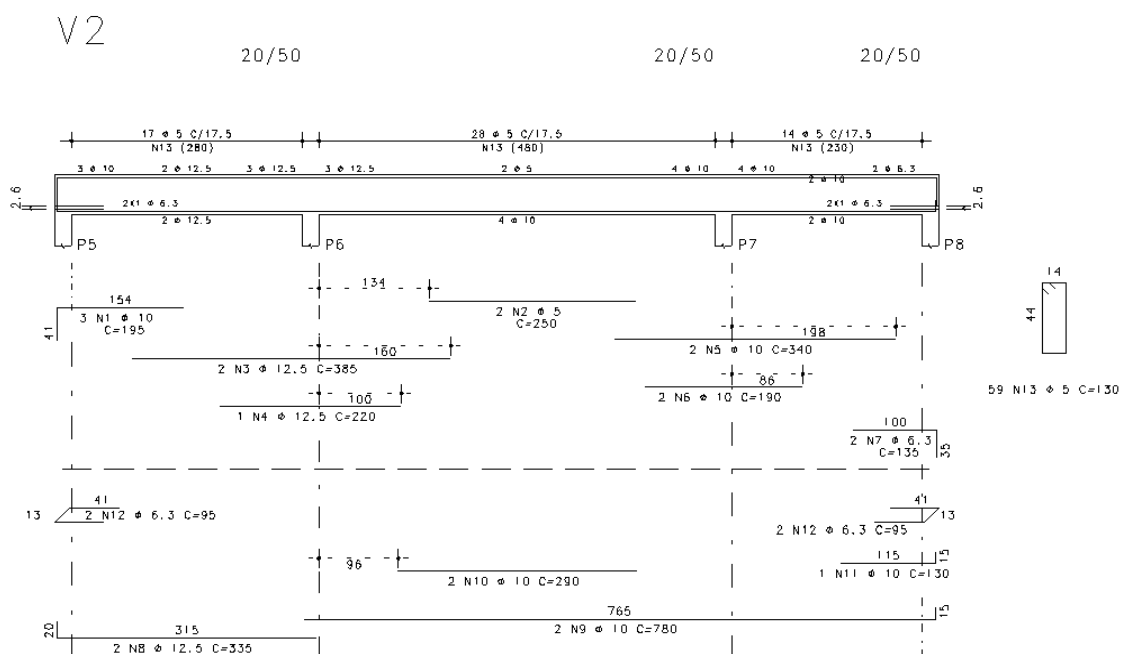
EXEMPLO 2 – ARMADURA DA V2
